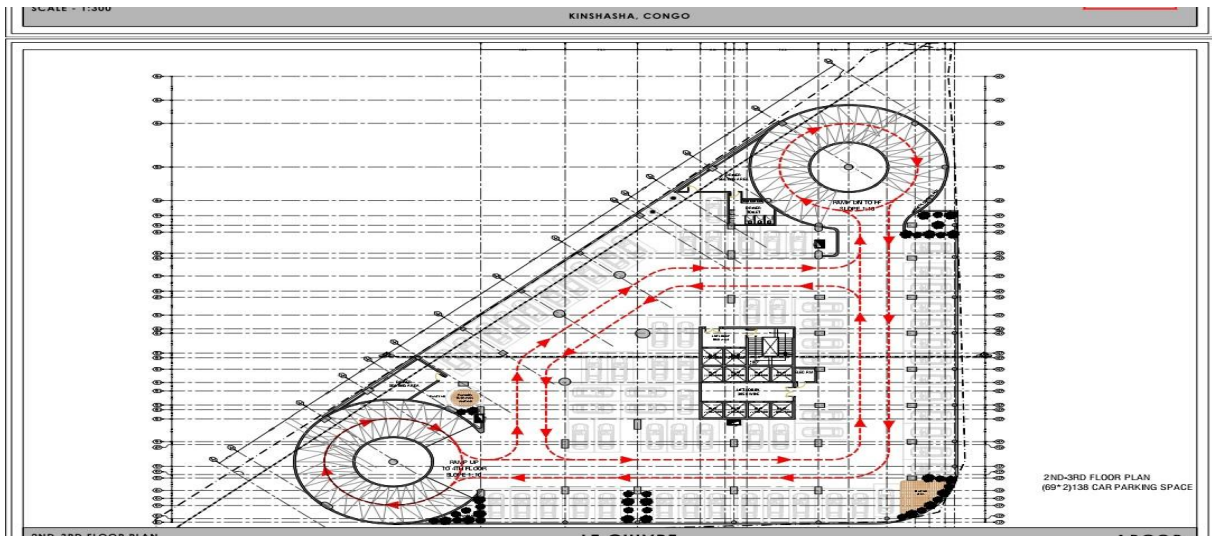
croquis de 2^e et 3^e niveaux, disposant de parking de capacité d'accueil de 69 véhicules chacun.
